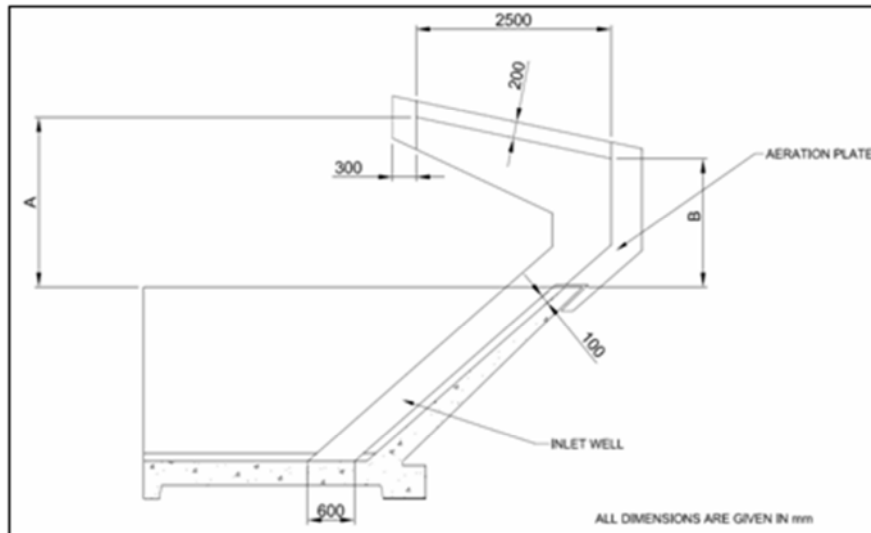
Vue en coupe d'une hausse fusible principale équipée d'un puits d'admission barrage Quipolly (Australie) [9].
